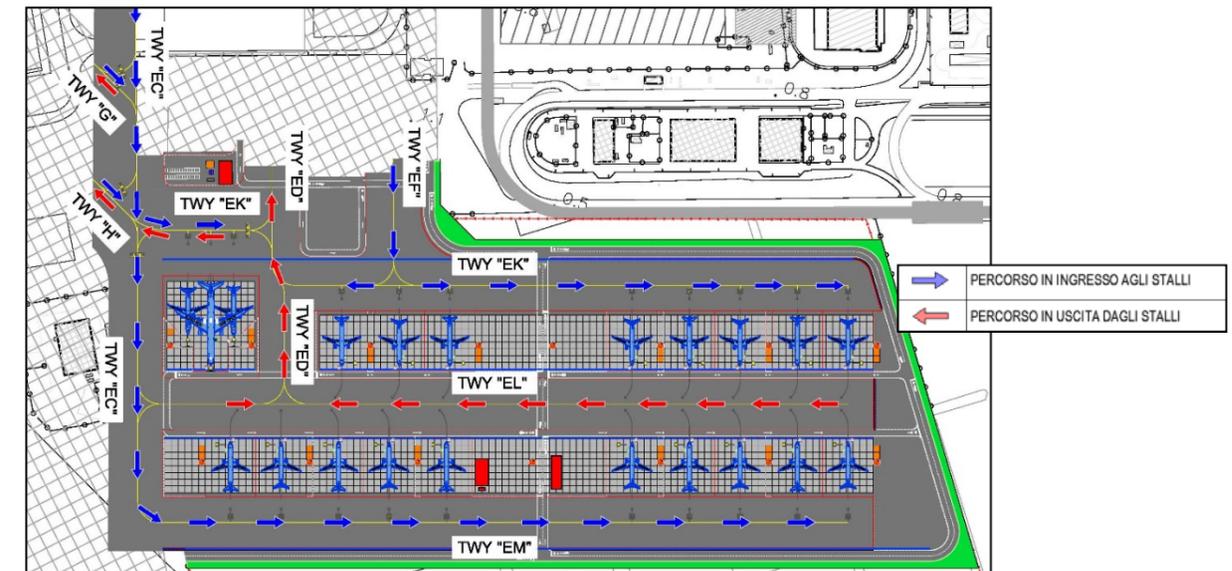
Layout dell'Apron Est con lo schema di circolazione delle taxiway
